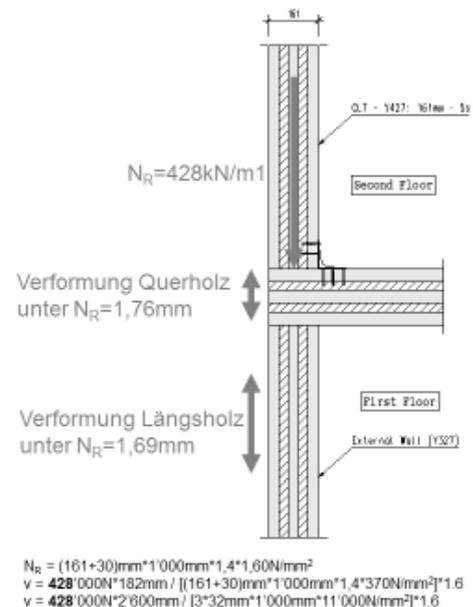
Konstruktionssystem mit Belastetem Querholz der Decken zwischen den Tragwänden. Die Maximale Traglast beträgt bei 161mm starken Wänden 428kN, die daraus resultierende Vertikalverformung eines Geschosses (Decke plus Wand) 3,45mm.
